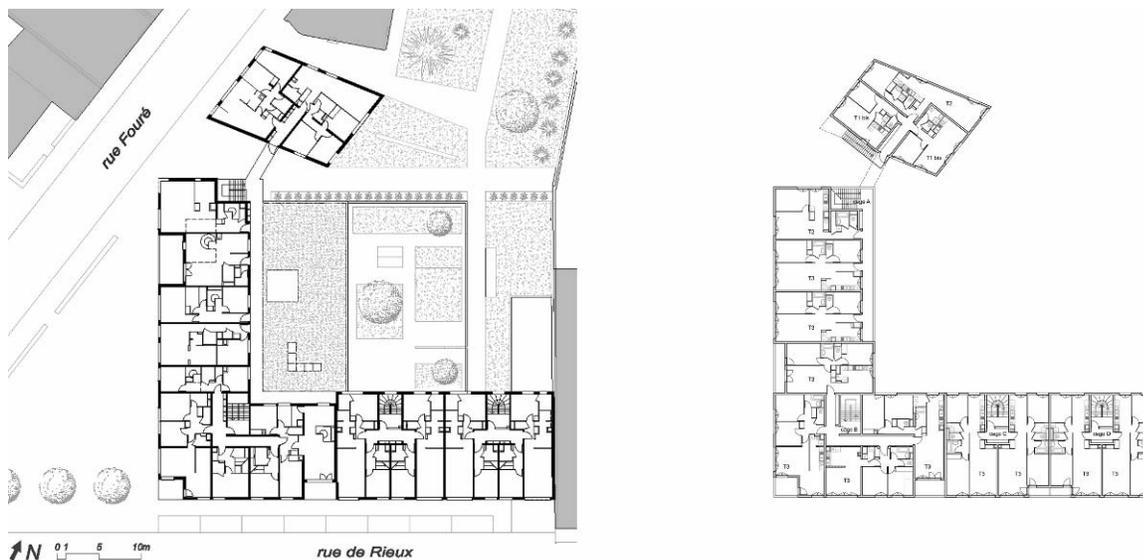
Plantas térreo e 1º pavimento (s/esc).
